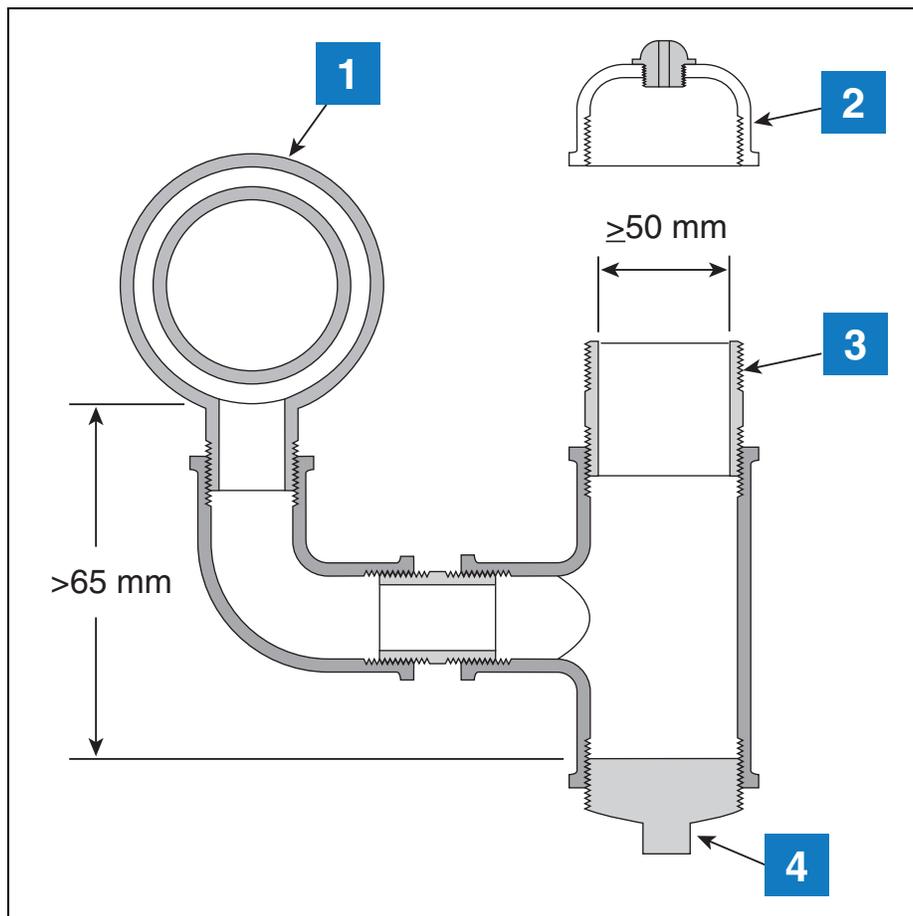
Exemplo de Instalação de Cárter de Tubulação de Duplo Revestimento
